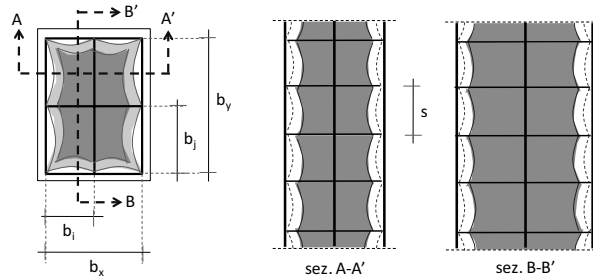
Rapporto tra il volume di calcestruzzo effettivamente confinato e il volume di calcestruzzo racchiuso dalle staffe.
